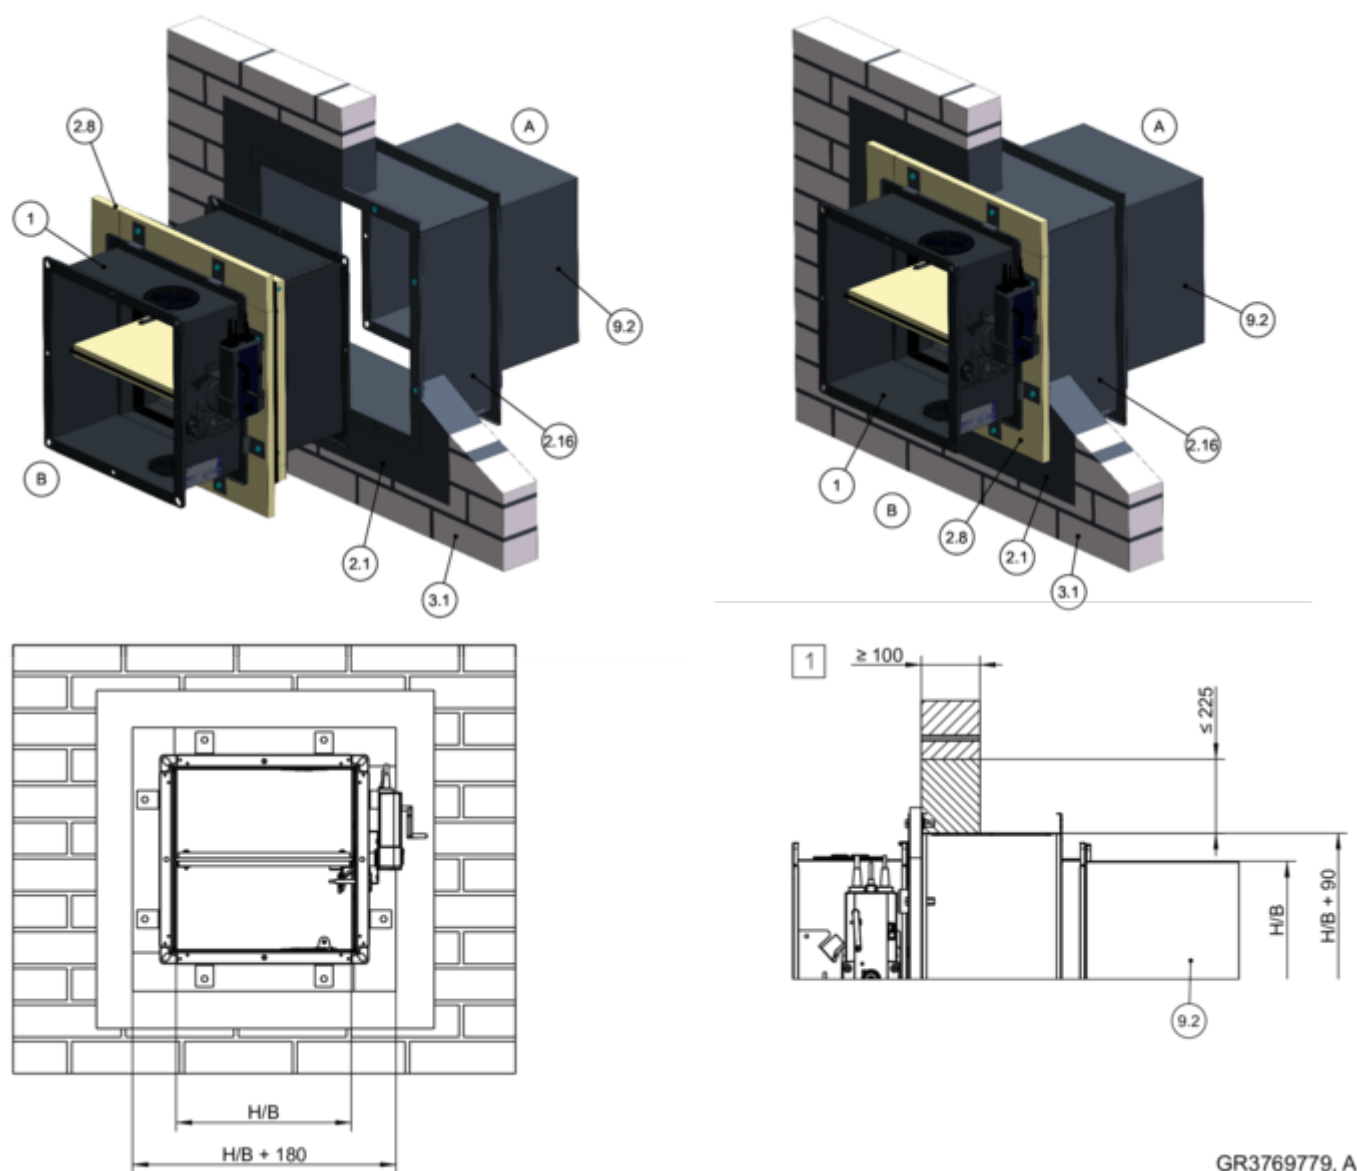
Montage à sec sans mortier dans un mur plein avec kit de montage E3 dans contre-cadre existant E1/E2
